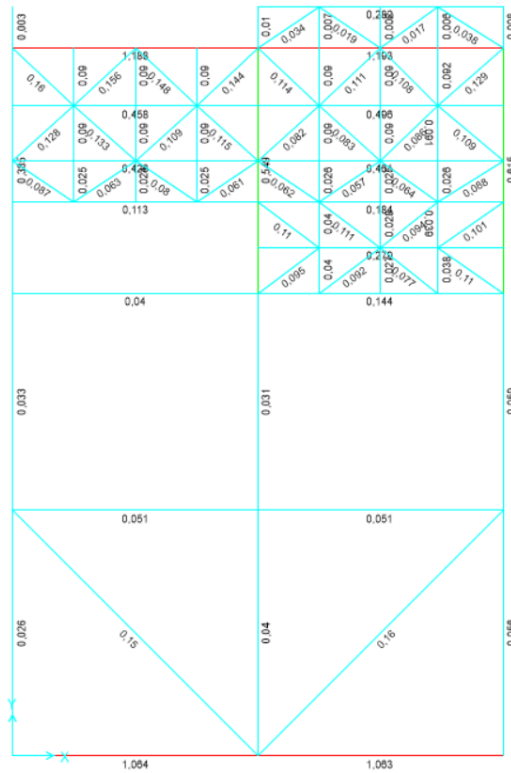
Factores de utilización vista en planta elevación 8.54 m.
